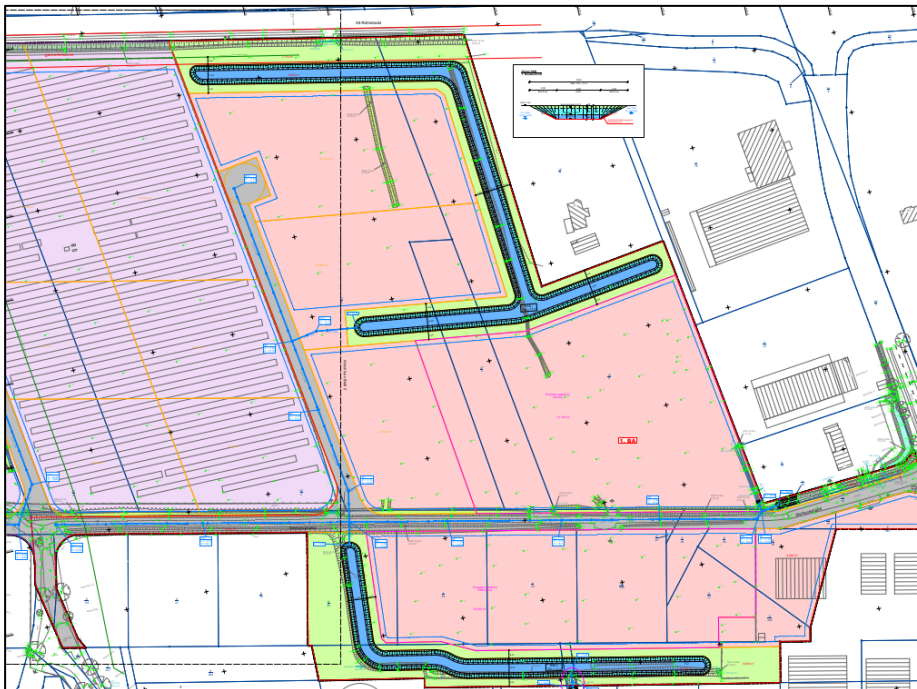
Geplante Entwässerung im 1. Bauabschnitt (östliches Plangebiet)
